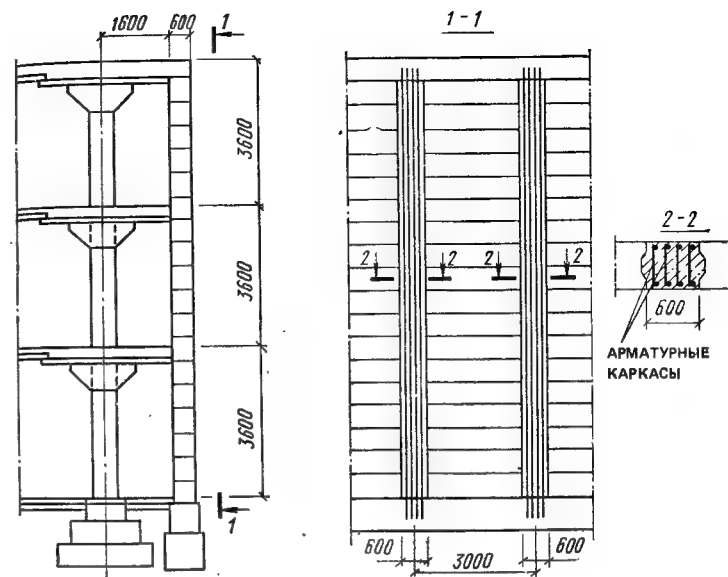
Фрагмент устройства наружной стены многоэтажного убежища из бетонных блоков
